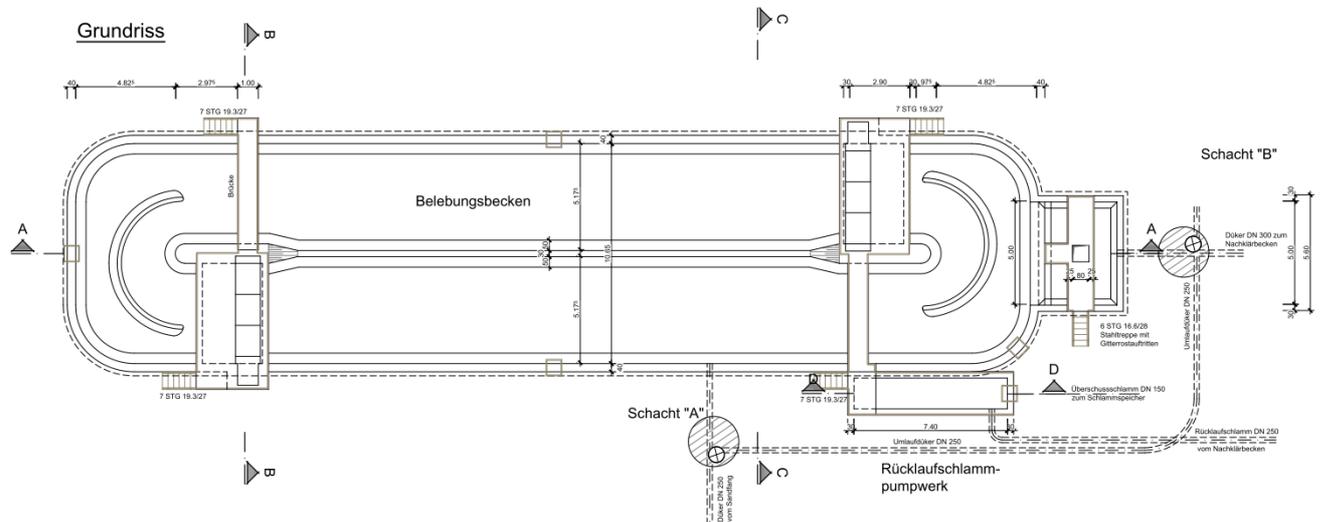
Grundriss Belebungsbecken und RS-Pumpwerk
